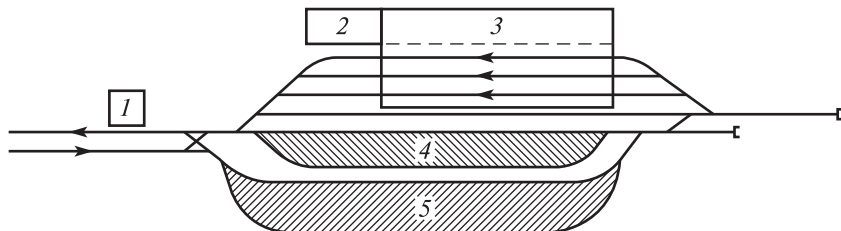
Принципиальная схема размещения устройств локомотивного хозяйства: 1 — контрольный пост; 2 — административный корпус; 3 — ремонтный корпус; 4 — пути отстоя локомотивов; 5 — экипировочные устройства
